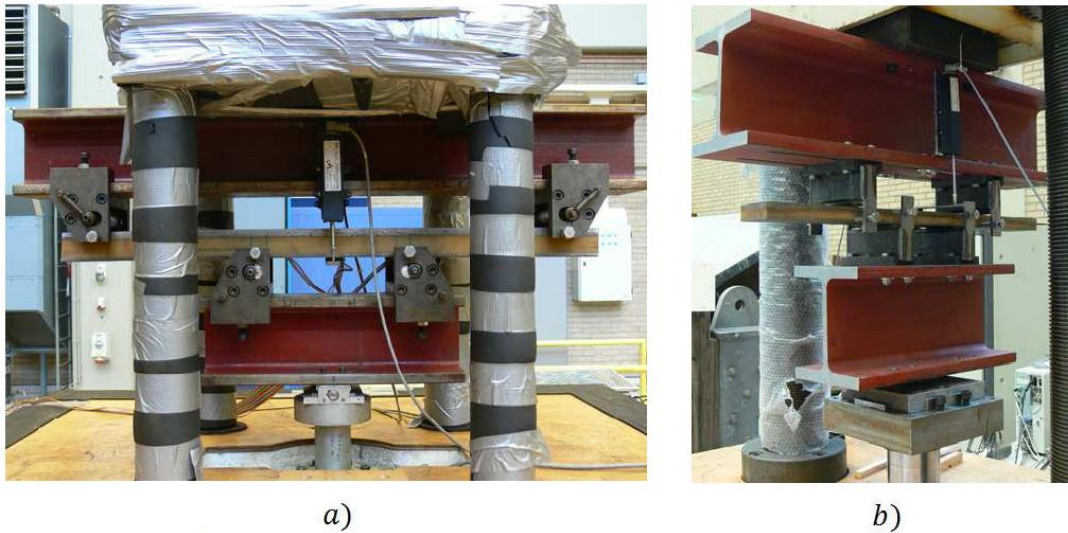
Montagem para ensaios à flexão. Configuração para: a) vigas longas; b) vigas curtas, [18].
